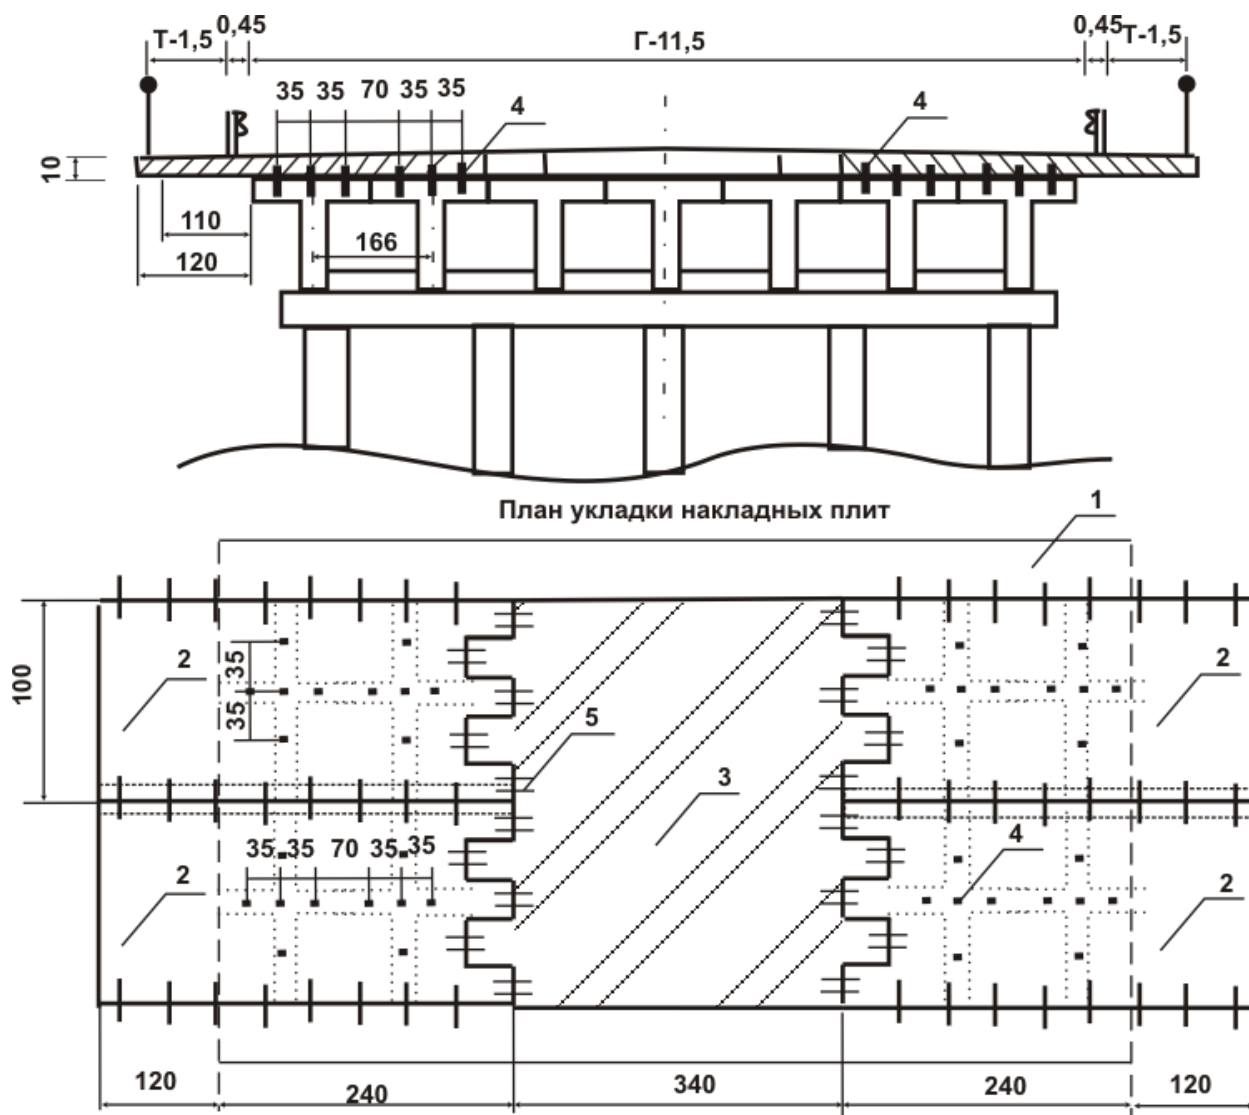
Уширение габарита моста накладными плитами: 1 – плита существующего моста; 2 – боковые накладные плиты уширения; 3 – средний участок монолитного бетона; 4 – металлические штыри против сдвига накладных плит; 5 – уступы сборных плит с выпусками арматуры
